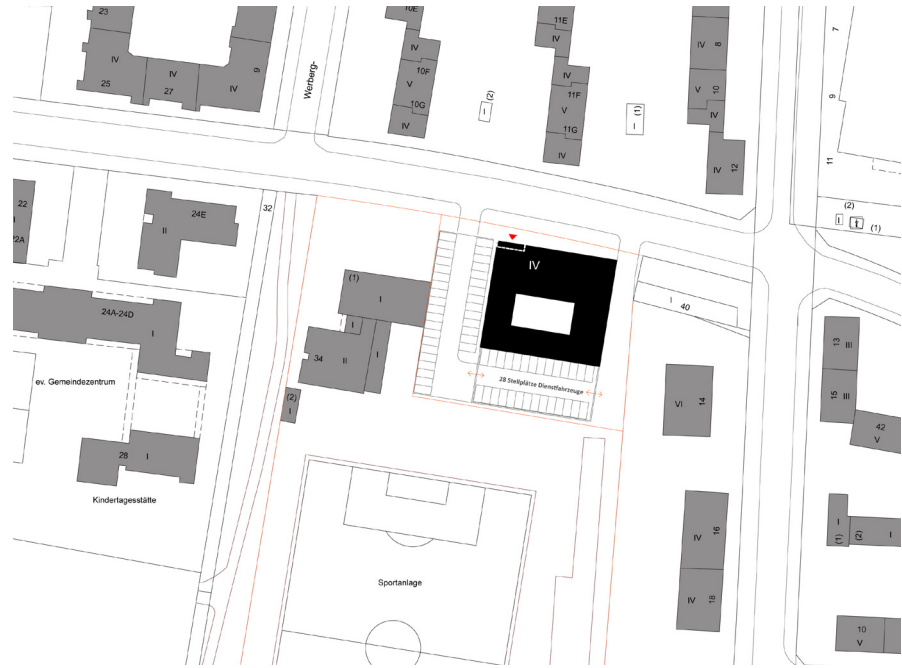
Machbarkeitsstudie: Neubau Götzstraße 36 / Lageplan
